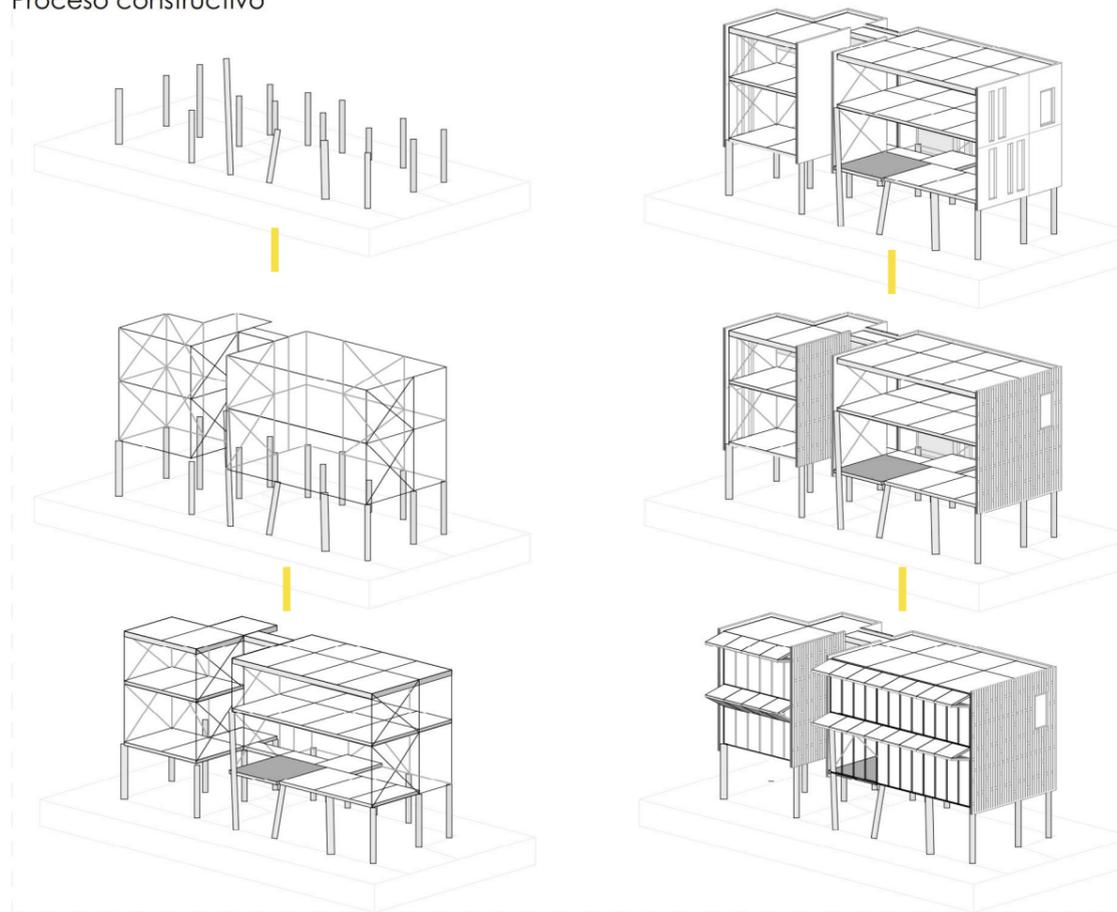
Proceso constructivo. Fuente: Autoría propia.
